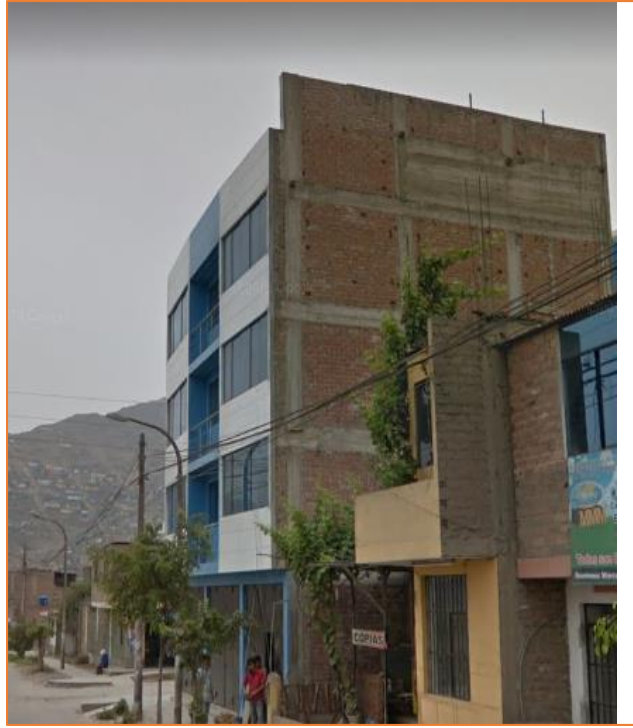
Edificación de albañilería con muros inestables segundo nivel.
